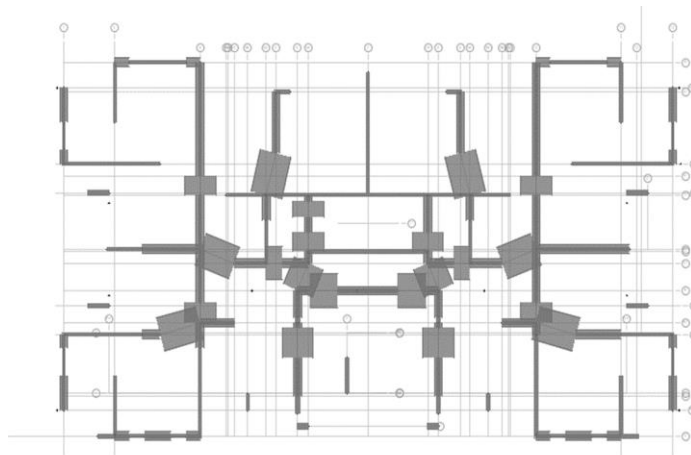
Distribución de vigas como reemplazo de losa en planta piso tipo.
